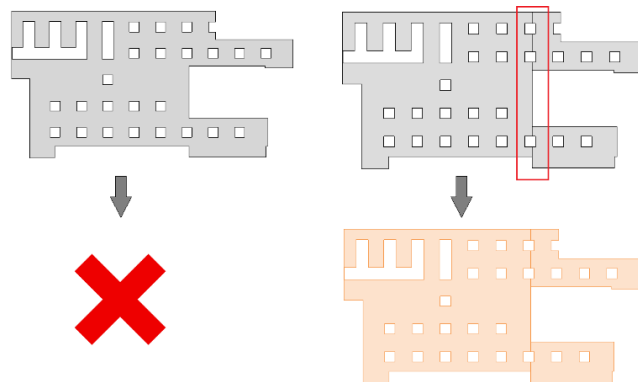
Comparação entre soluções de modelação da laje do piso 0 antes e depois da divisão da laje
